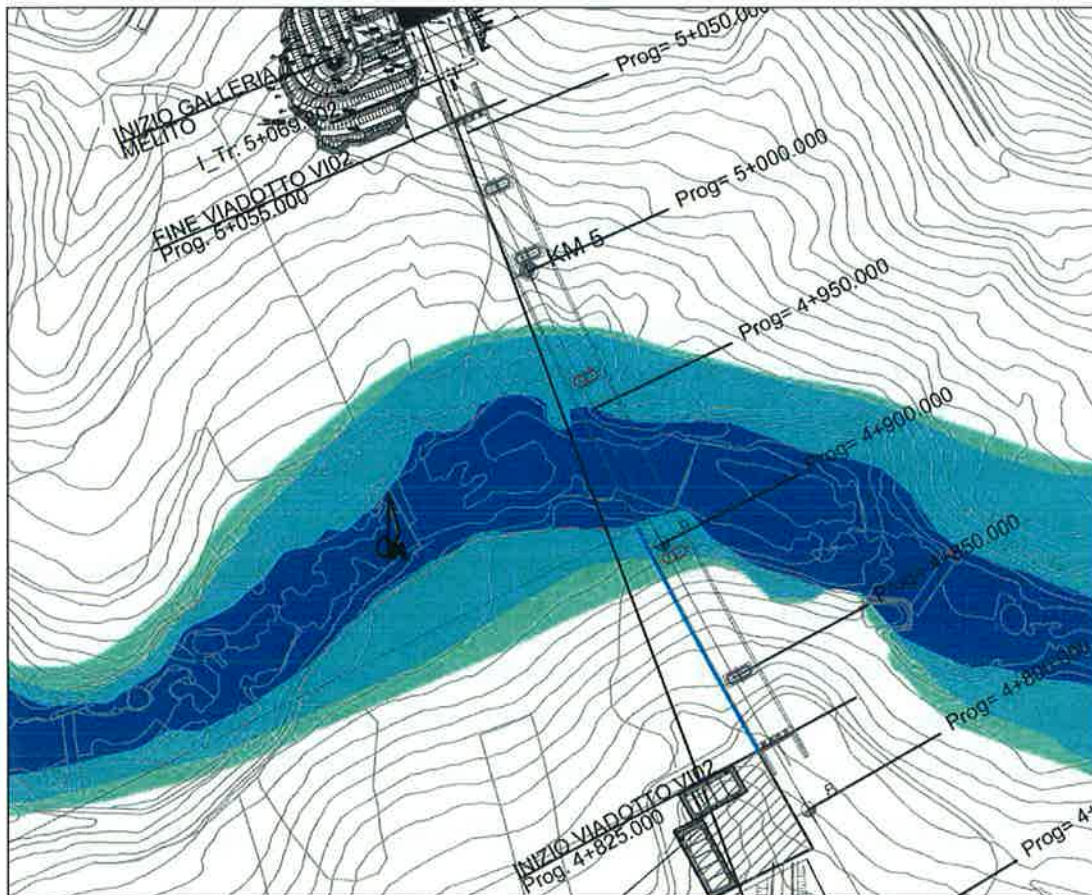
Stralcio planimetrico del PAI vigente in corrispondenza del viadotto VI02 di progetto
